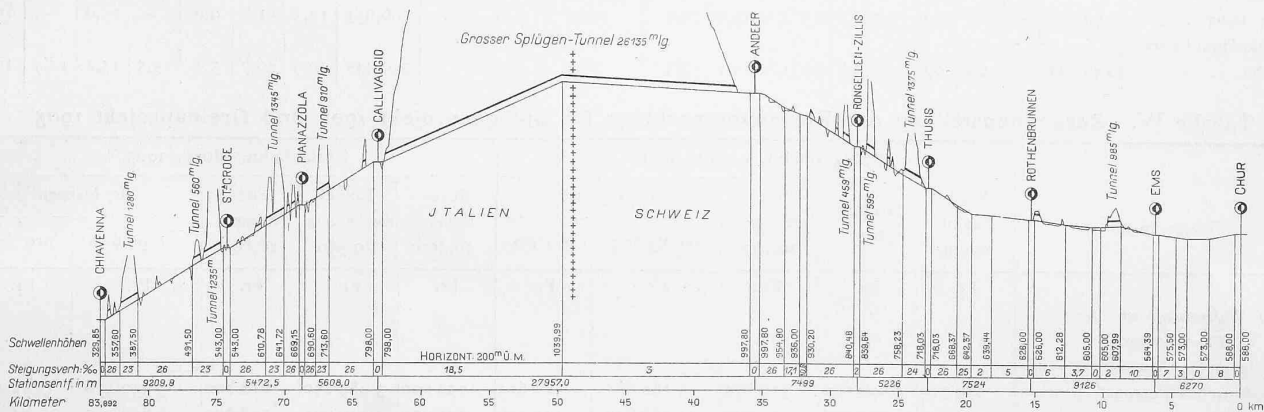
Längenprofil des Splügenprojektes Locher 1906. — Masstab für die Längen 1 : 500 000, für die Höhen 1 : 20 000.
